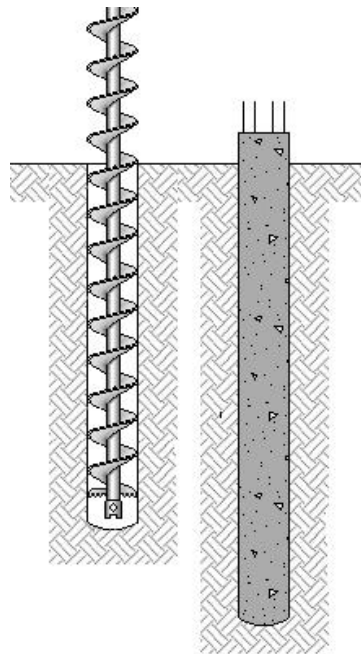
Pilote Excavado y vaciado con máquina tipo hélice continua
